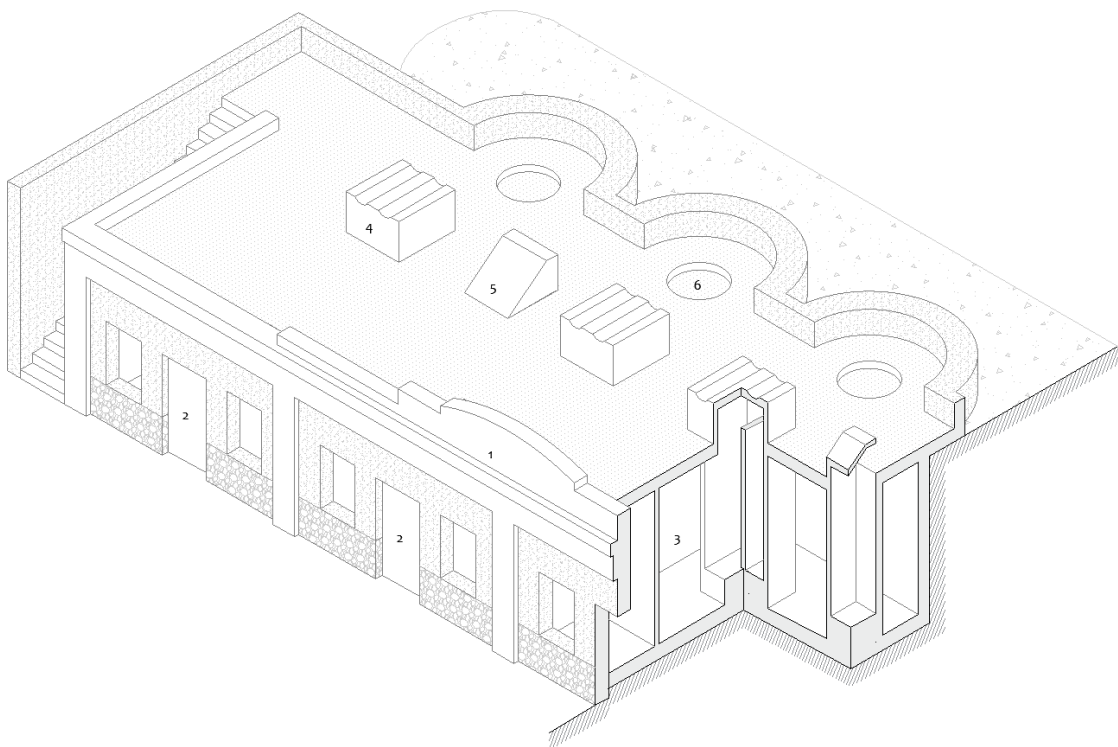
Axonometría seccionada tipo de los edificios de repuestos en las baterías antiaéreas artilladas con Vickers A.A. 10,5/45 cm: 1. Fachada a retaguardia, 2. Sala de repuestos, 3. Cámara de montacargas, 4. Montacargas, 5. Conducto de vainas vacías, 6. Barbeta. (Dibujo propio)
